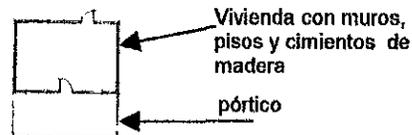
Vivienda de madera de ensamblaje procedente de Los Estados Unidos (planta).
